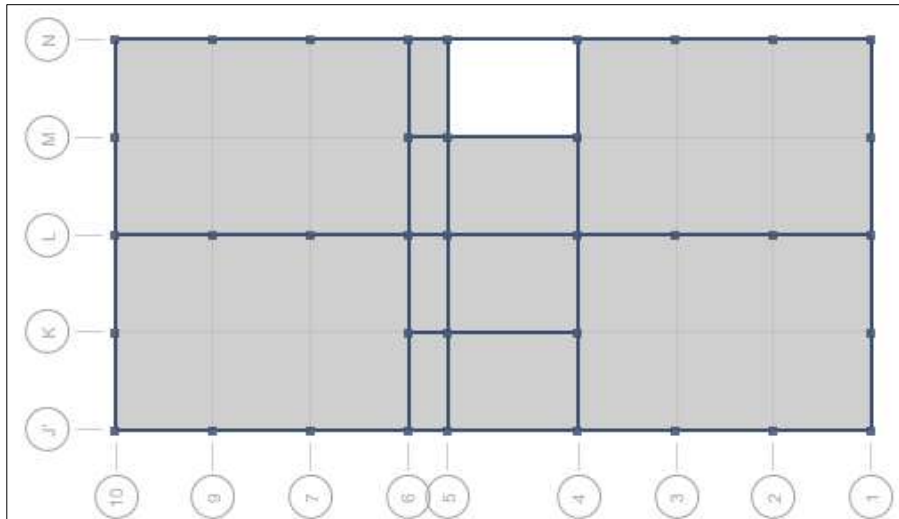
Planta Estructural N+3.61 Estructura 4.31
